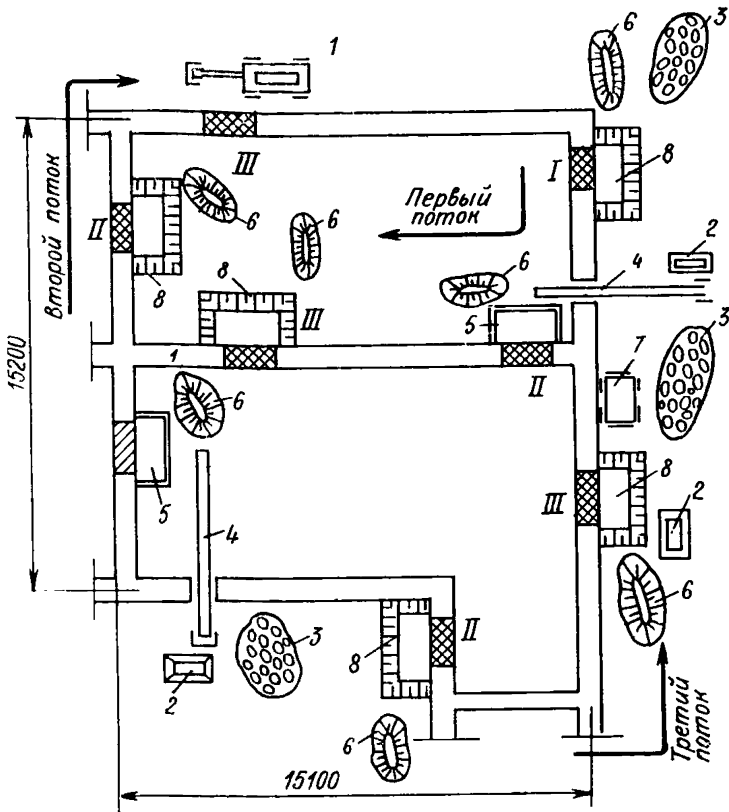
Схема организации работ по перекладке отдельных участков фундамента
